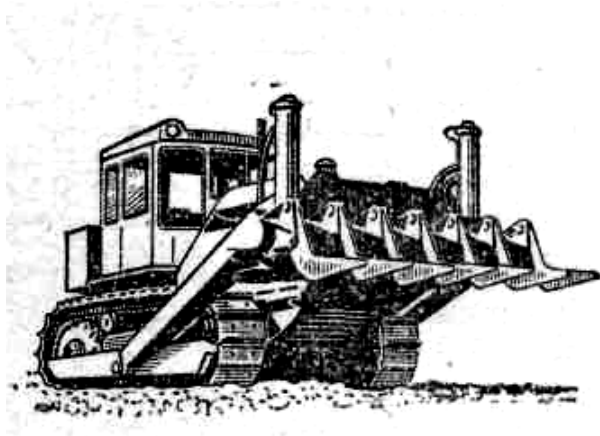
Общий вид корчевателя-собирателя с передними подъемными гидроцилиндрами
